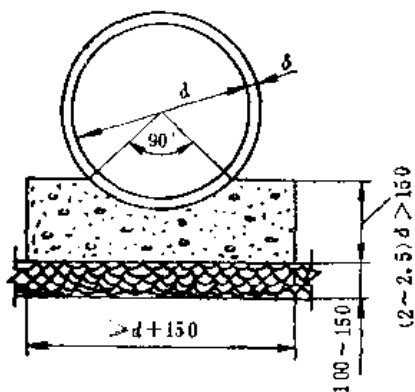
混凝土基础(混凝土标号应不小于100号)
